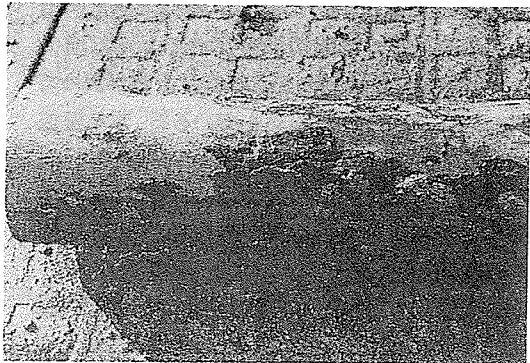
胴木 皮剥ぎ松丸太(径 120mm)
